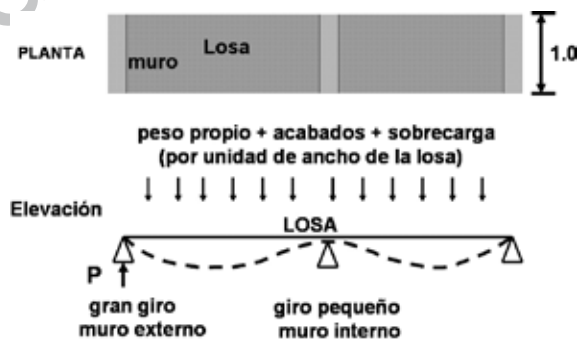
Giros de la losa. «P» es la reacción en el apoyo extremo.
